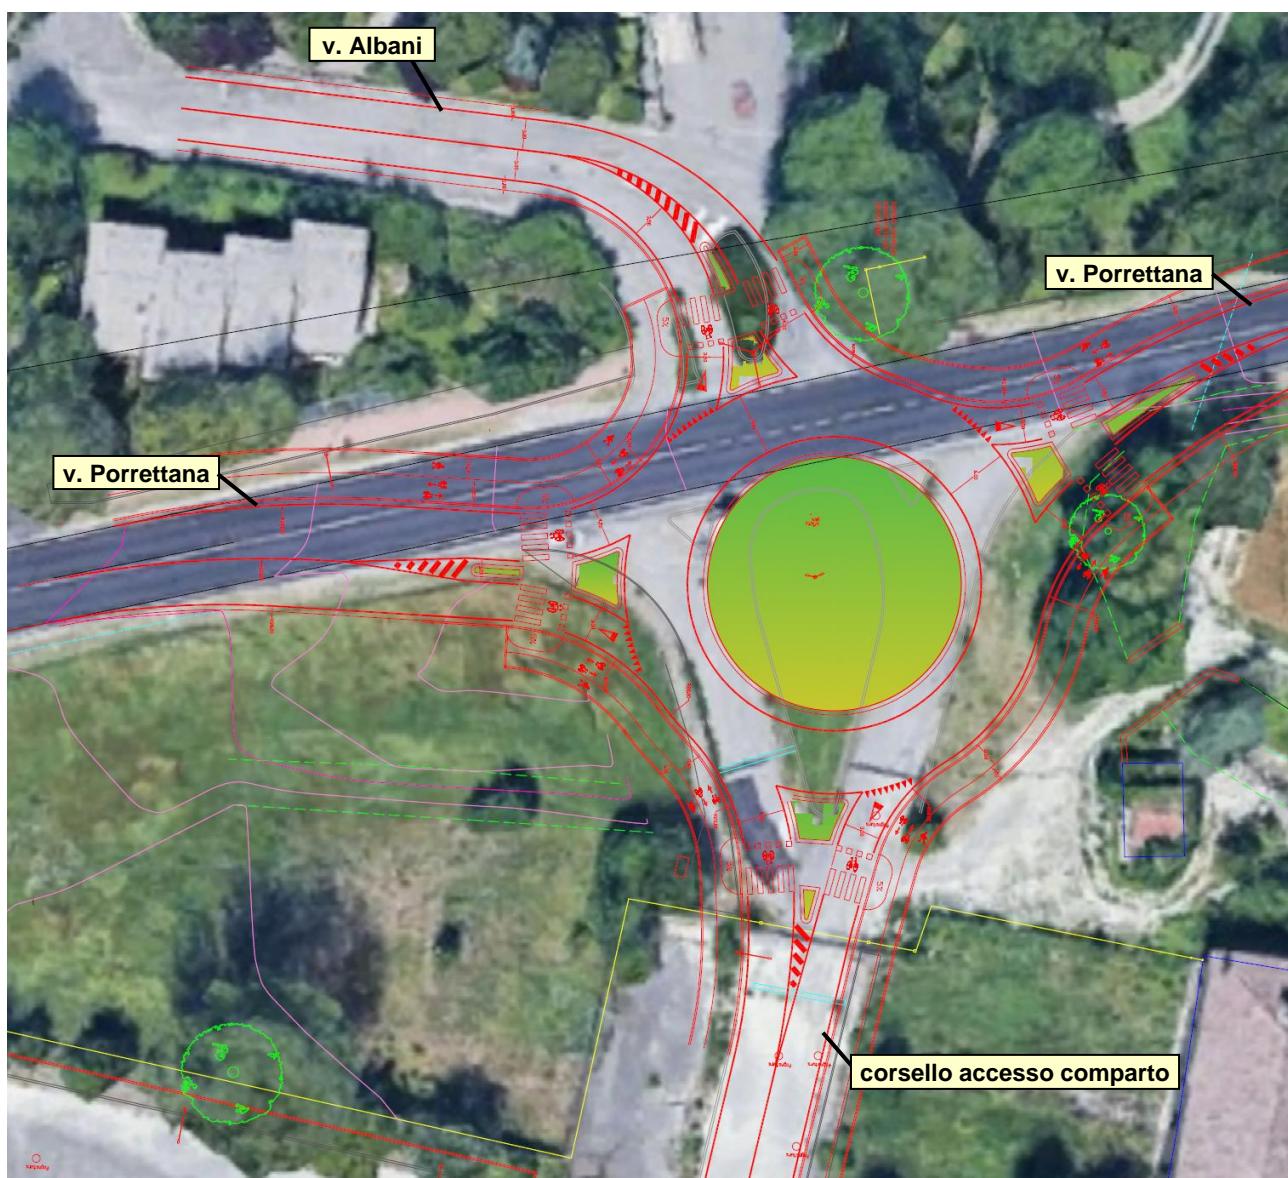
Schema planimetrico preliminare della rotatoria di progetto
